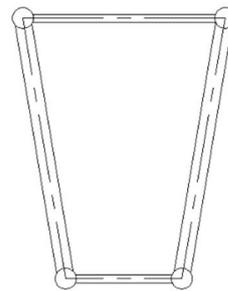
Sección transversal en los módulos tipo. Fuente: elaboración propia.
